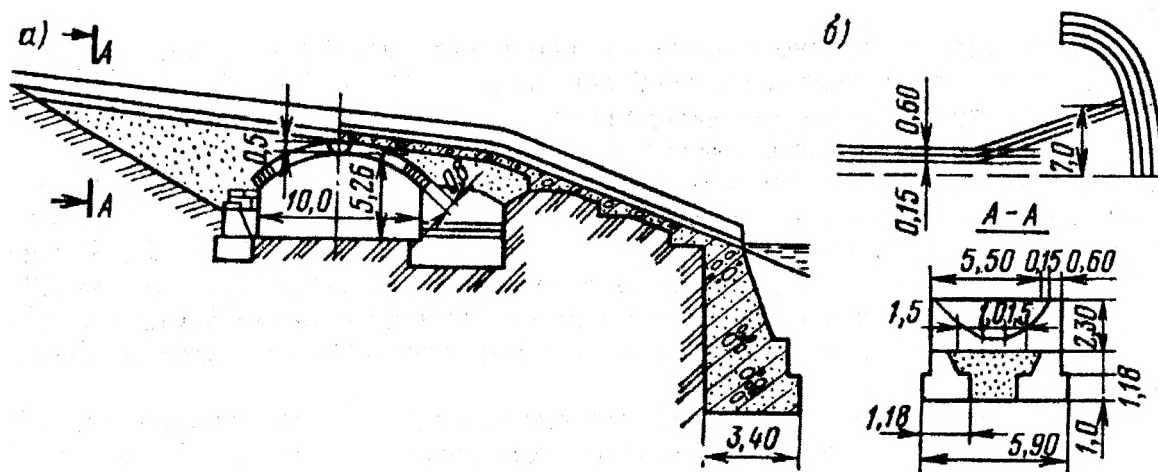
Конструкция селедука: а – общая схема; б – план конечного участка
